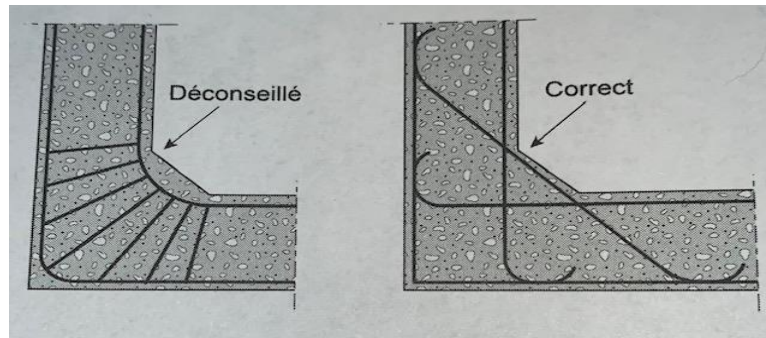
Poussée au vide par fléchissement de la barre ancrée [13].
